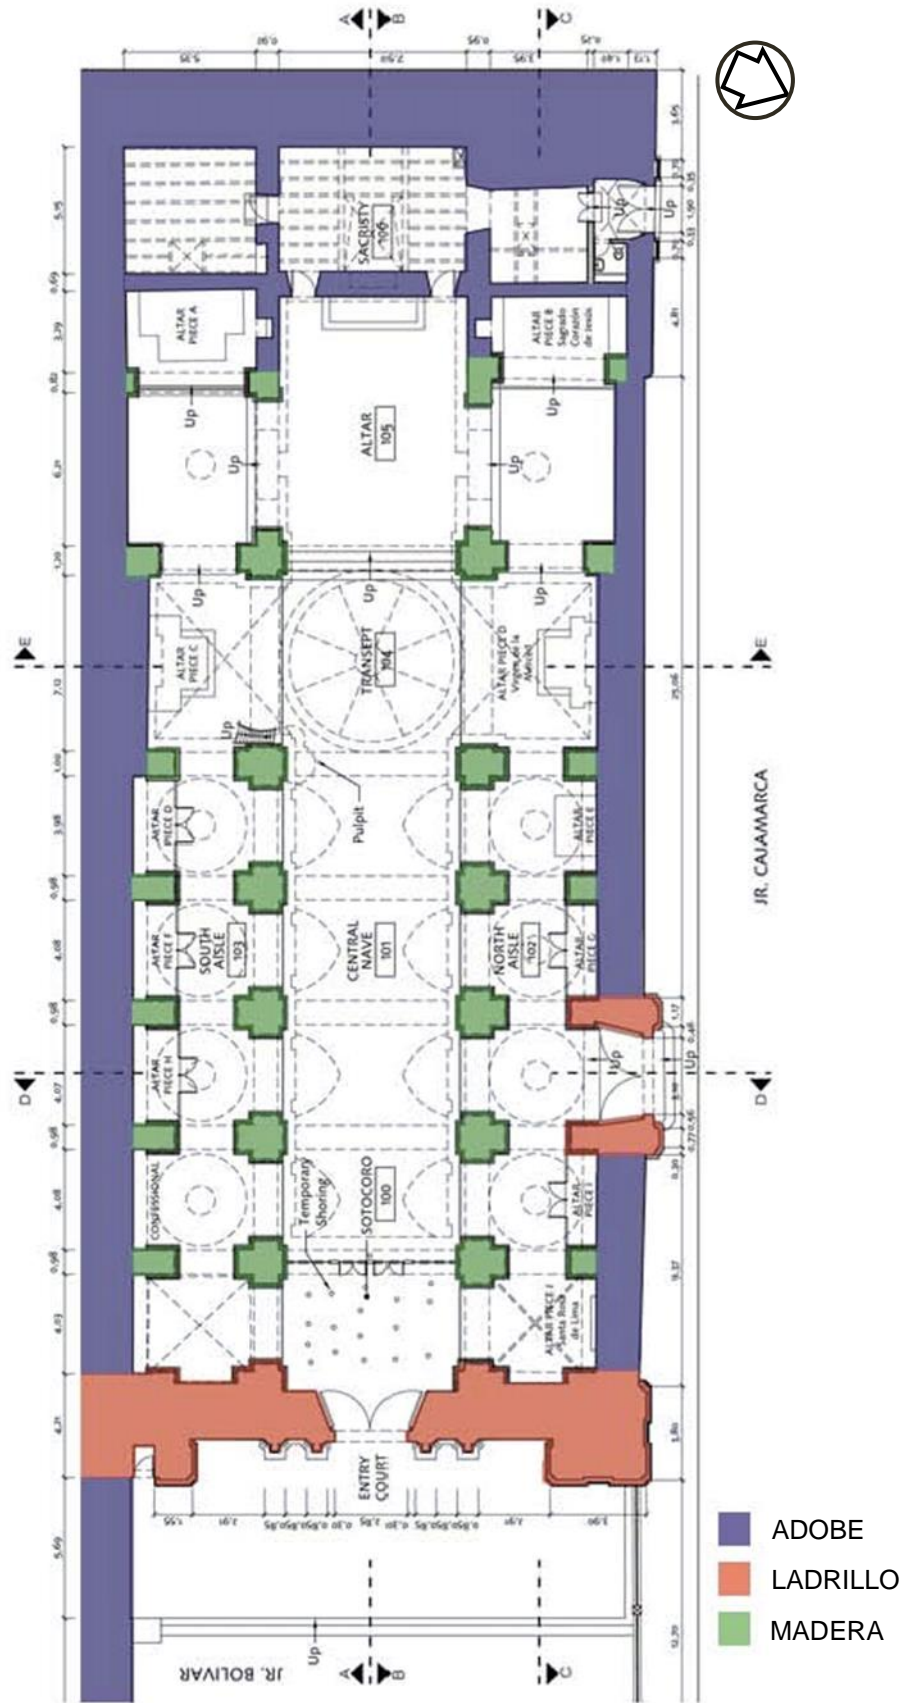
Disposición de la Catedral - Vista en planta [1]
